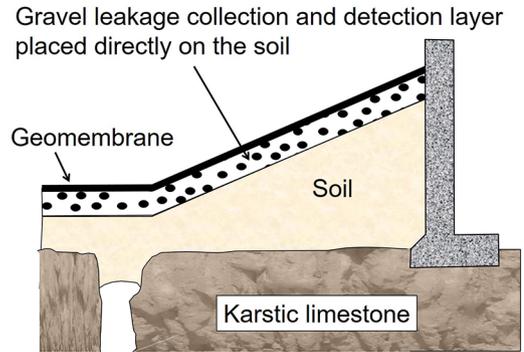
Coupe schématique (non à l'échelle) du site sur lequel le réservoir a été construit.
